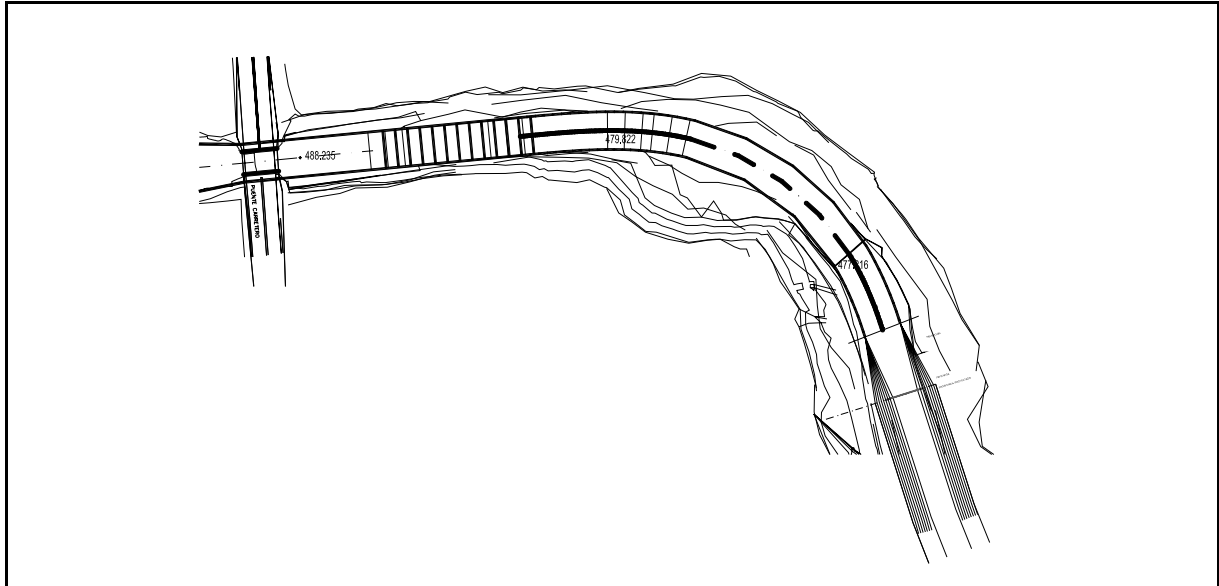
Plano en planta de la implementación de la transición entre la estructura proyectada y la estructura antigua
